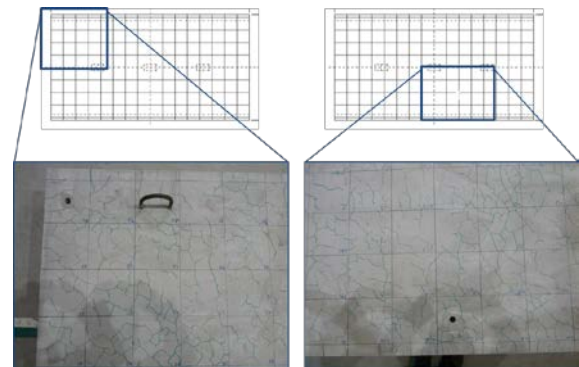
上面水はり試験体 No.6 載荷前のひび割れ(上面)
